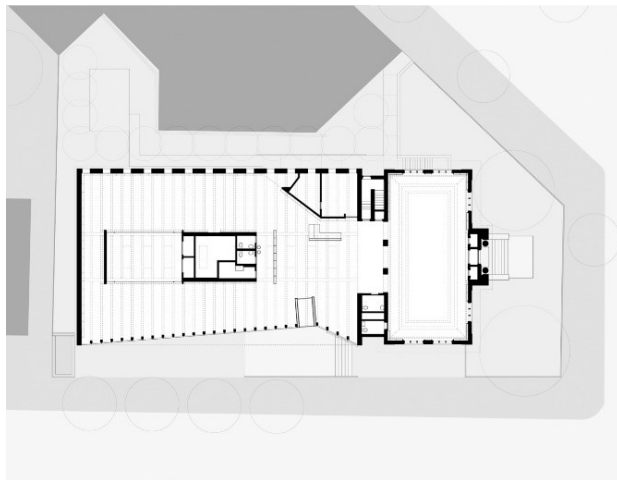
Planta baixa simples. Fonte: archdaily.com.br/
